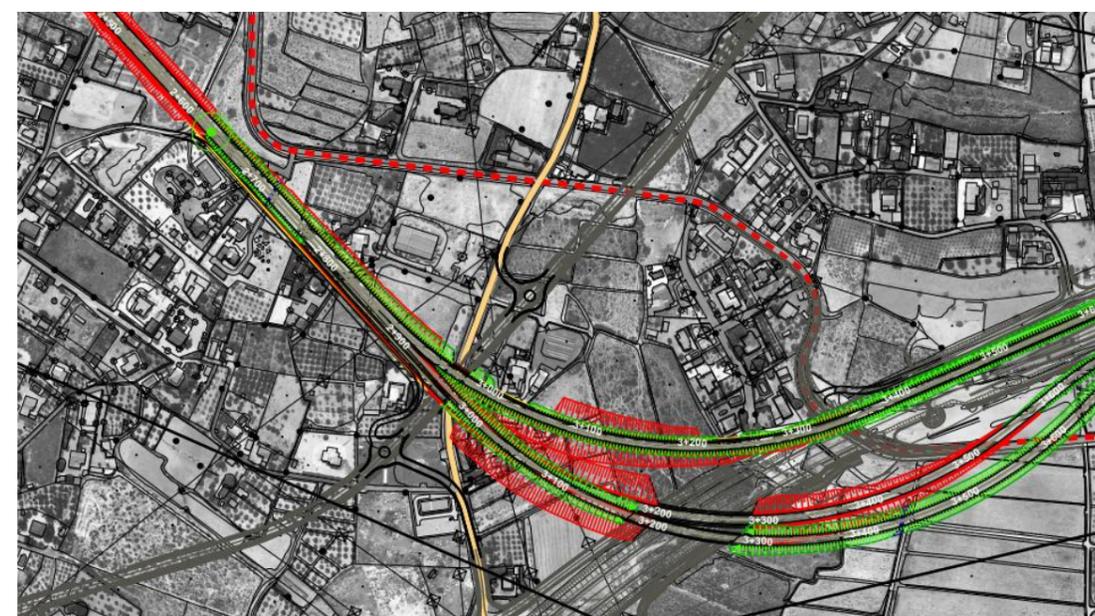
TRAZADO ACTUAL DE LA COLADA DE MATOLA O DE SANTA TERESA QUE ATRAVIESA LA TRAZA DE LA VARIANTE DE ELCHE Y SU REPOSICIÓN
